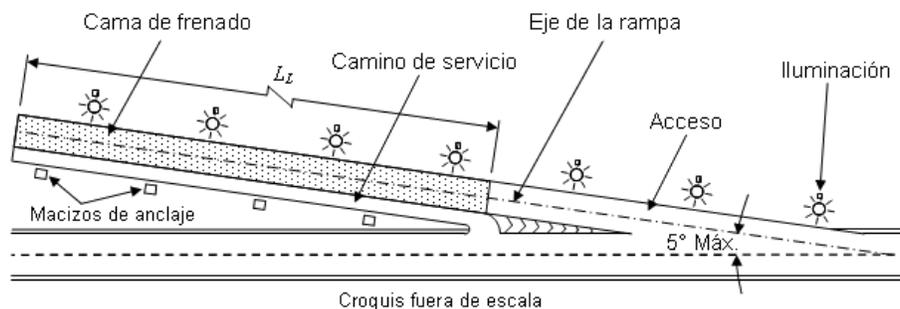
Rampa de emergencia para frenado. Disposición en planta
